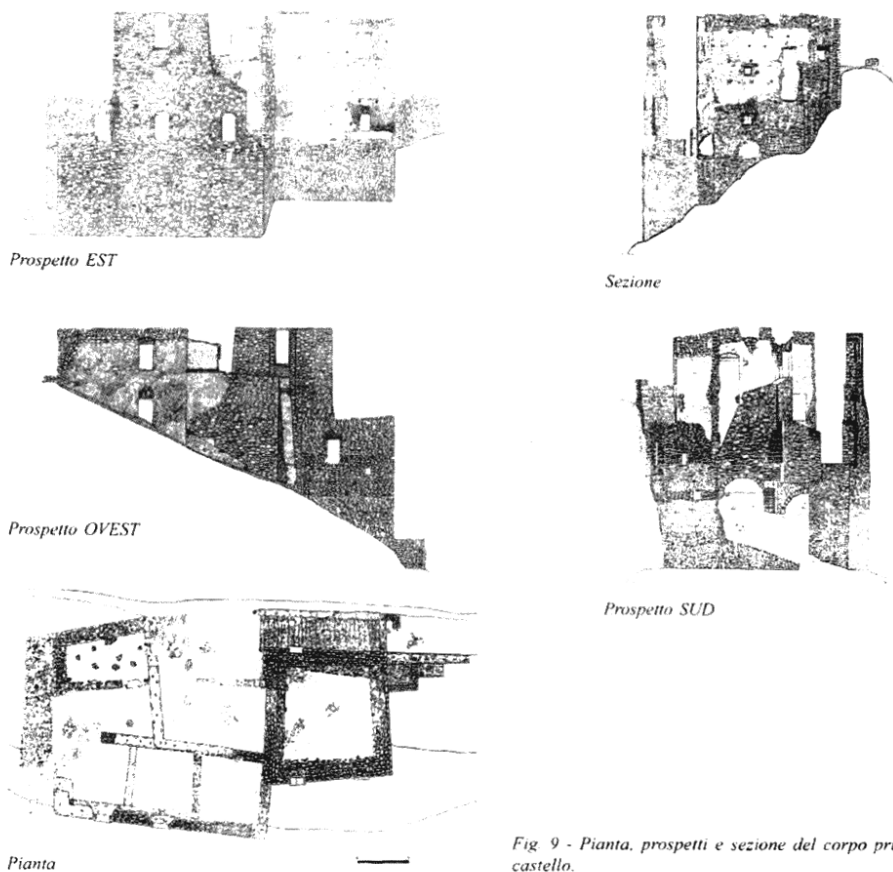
Pianta, prospetti e sezione del corpo principale del castello.
